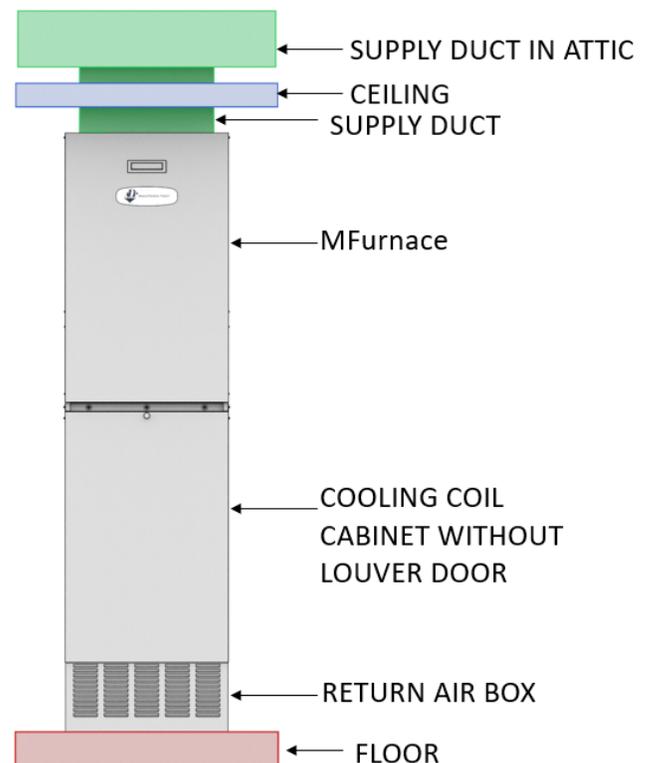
Installation ascendante typique avec conduit d'alimentation et boîte de retour d'air
